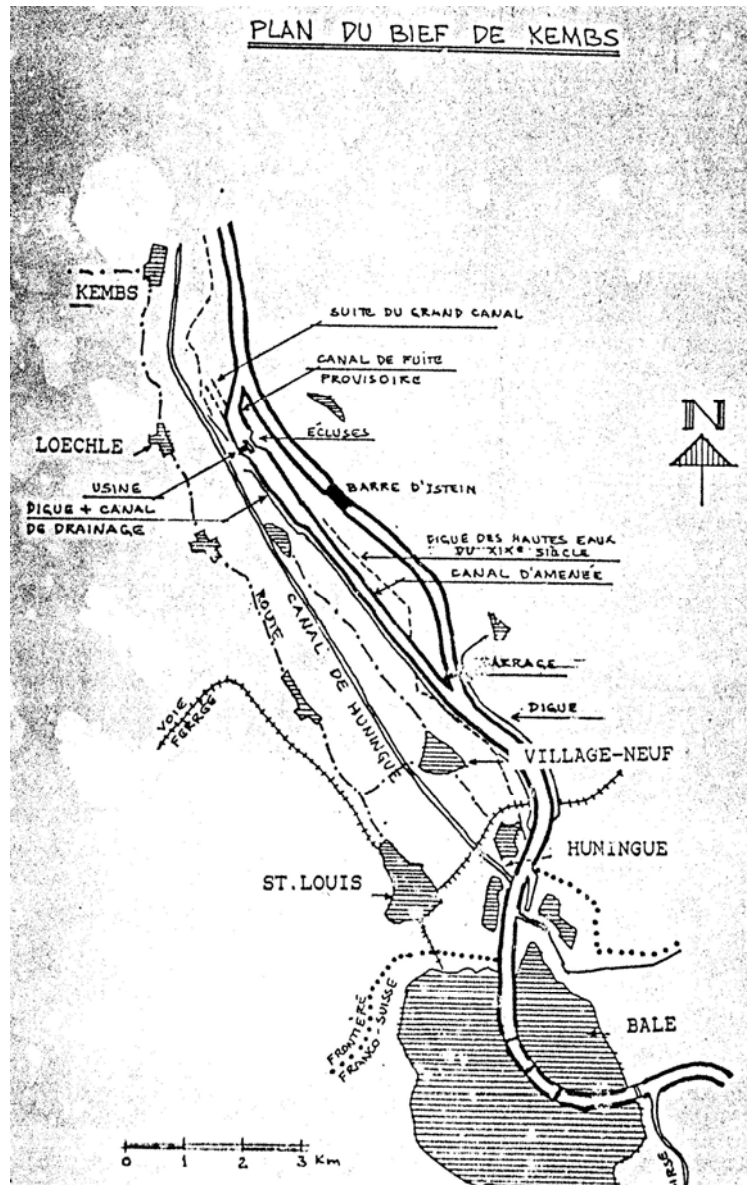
FIG. B Plan du bief de Kembs en 1930. ORTH, p. 187A. Le barrage, planté à 500m de la prise d'eau relève de 8 m le niveau du Rhin, d'où l'imposante digue rive droite face à Village Neuf ; l'onde de retour monte au-delà de Bâle. La dérivation a une section de 540 m² pour débiter au plus 850 m³/s à la vitesse de 0,7 m/s. Le canal d'amenée devient canal de dérivation. Les deux écluses peuvent recevoir les grands remorqueurs suisses à aubes. L'éclusée dure une bonne demi heure.
